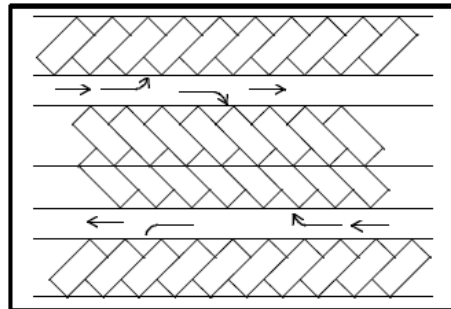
Pola Parkir Bentuk Tulang Ikan Tipe A Sudut 45 °, Off Street
